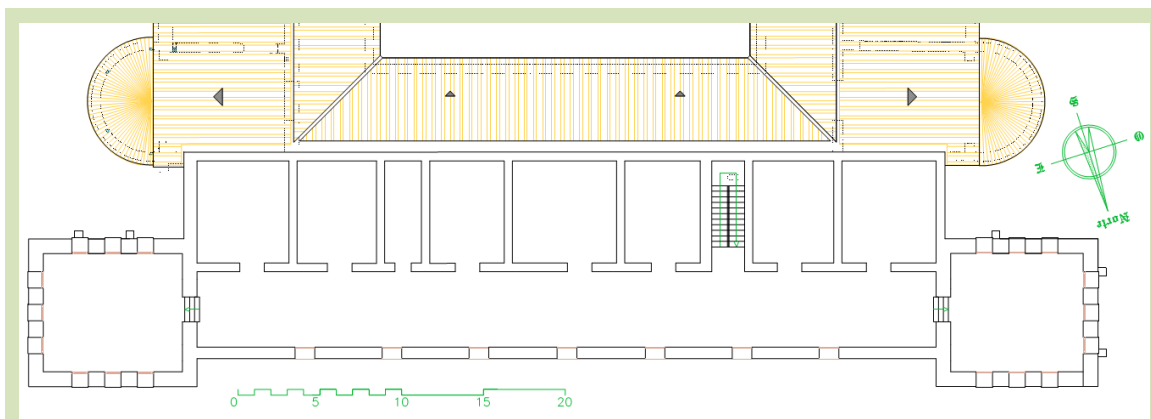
Ala norte, planta primera de La Olmeda (reconstrucción virtual -II-). CGS.
